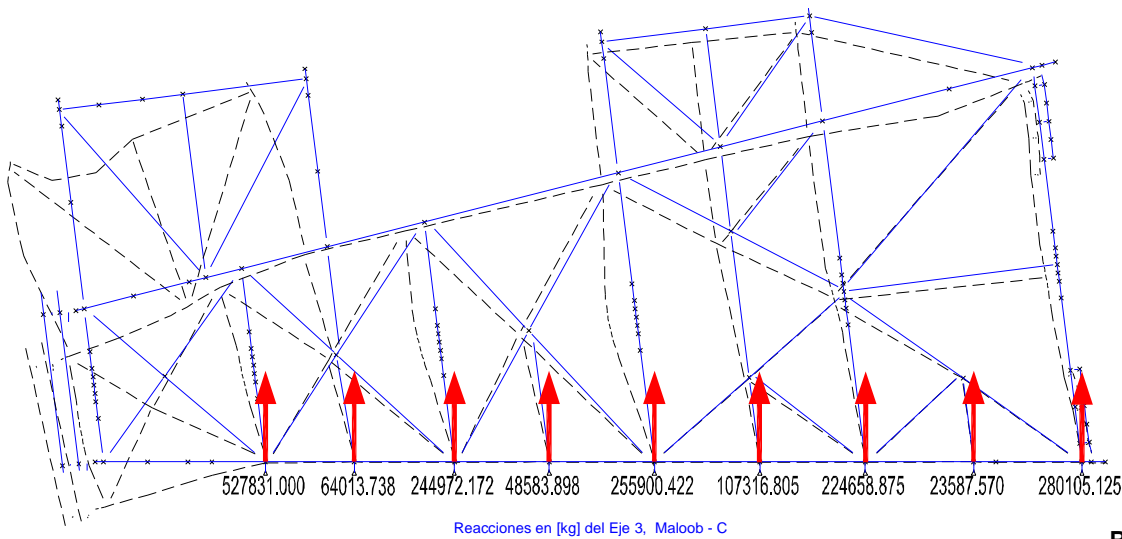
Fuerzas en la construcción y ensamble de la Subestructura
